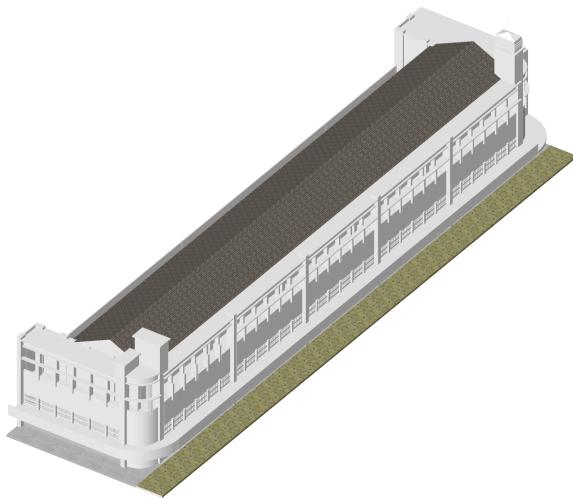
Site plan konsep, Sumber : Dok.Pribadi.
